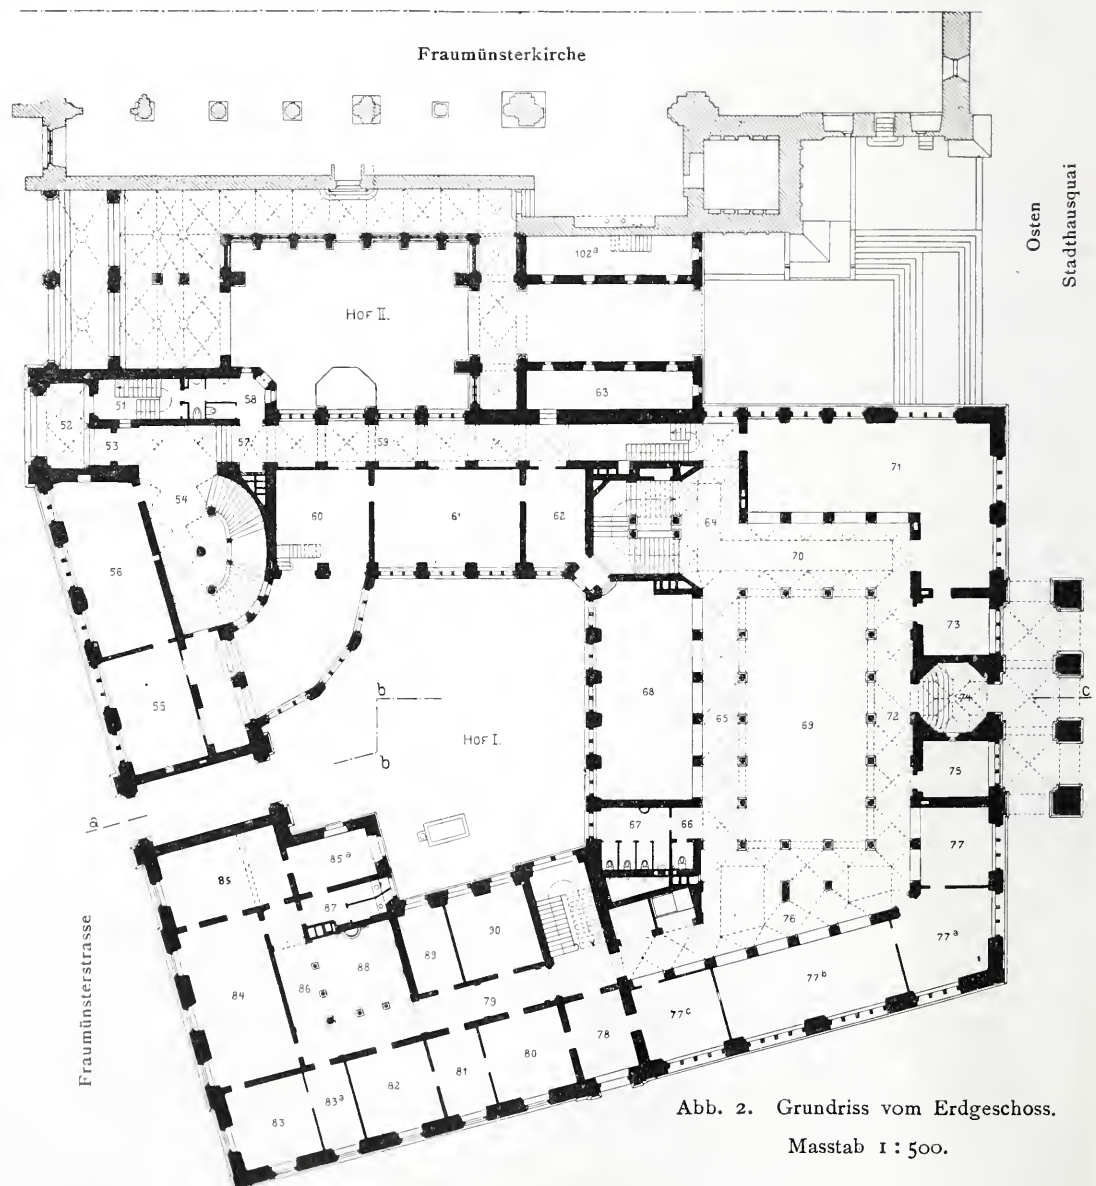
Grundriss vom Erdgeschoss.
